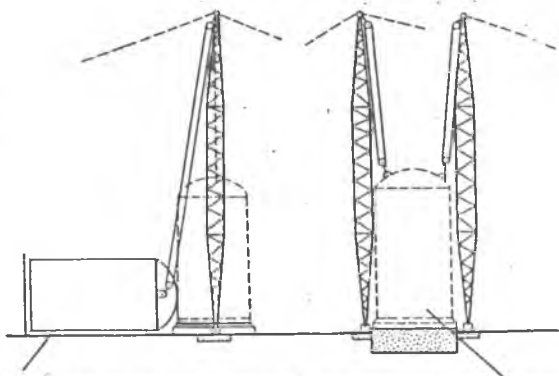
Схема монтажа тяжелого оборудования двумя мачтами
